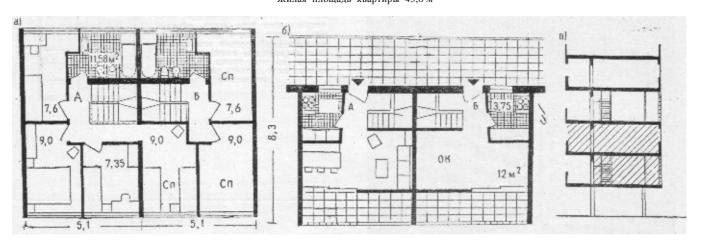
Галерейный дом с галереями через этаж и квартирами в двух уровнях (Бразилия) a — план верхнего уровня; δ — план на уровне галерея; δ — разрез На уровне галереи расположены общая комната и кухня, на верхнем уровне — три спальни и санузел. Жилая площадь квартиры $37.5\,\mathrm{m}^2$
